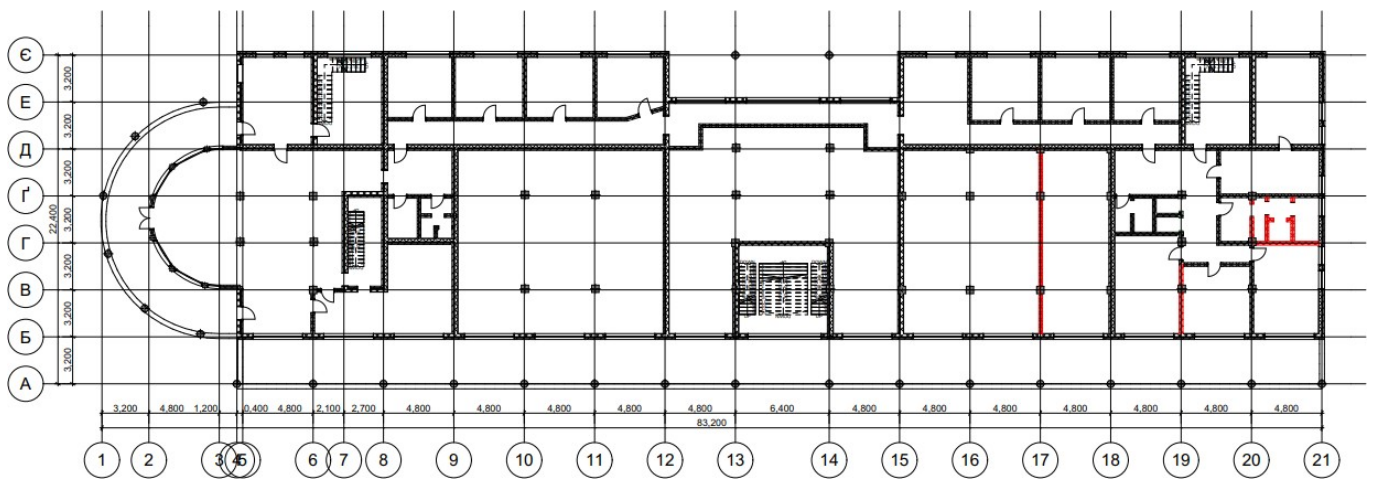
План 1 поверху з демонтажем стінових конструкцій
